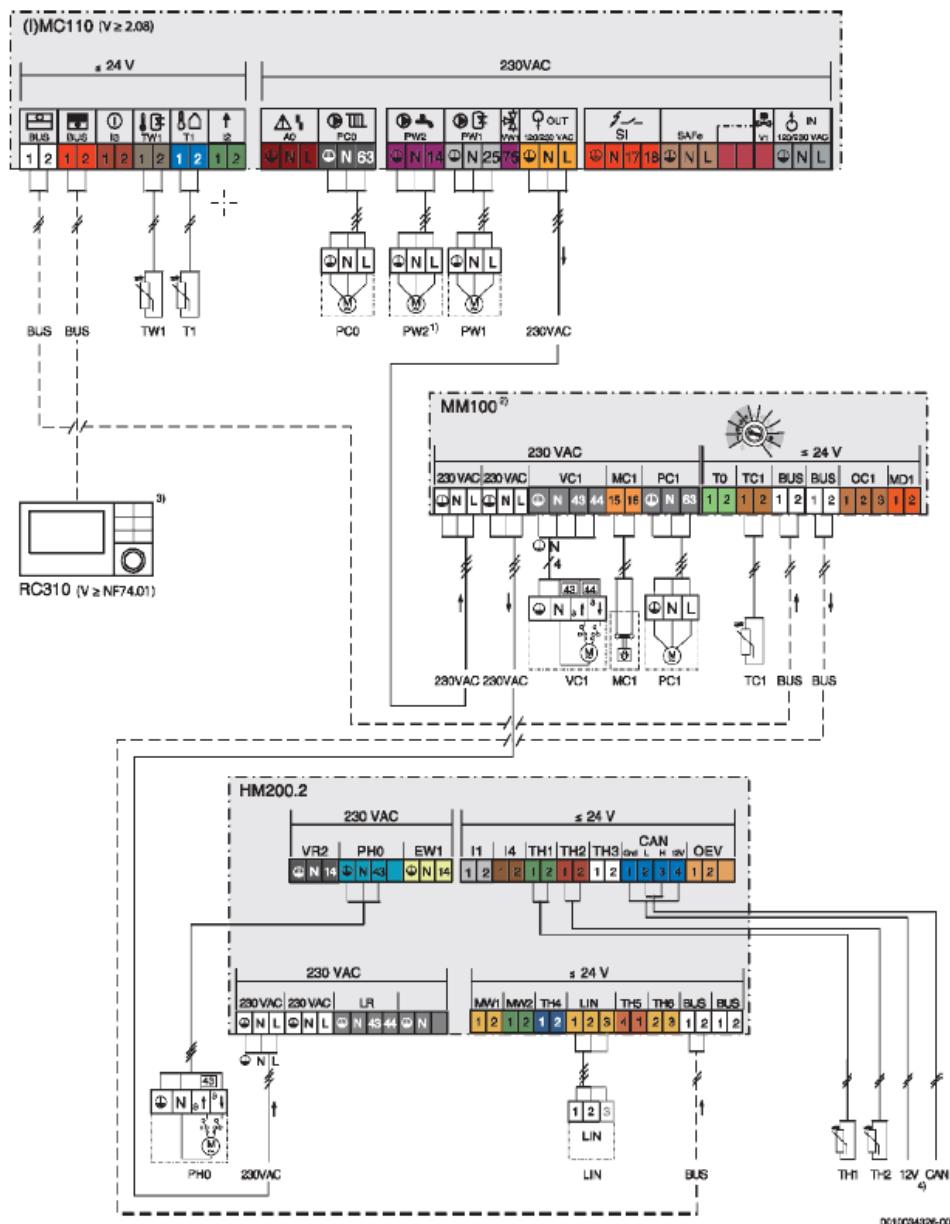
Schaltplan zum Hydraulikschemata (Quelle: [Planungsunterlage Hybrid, S.86](#))
